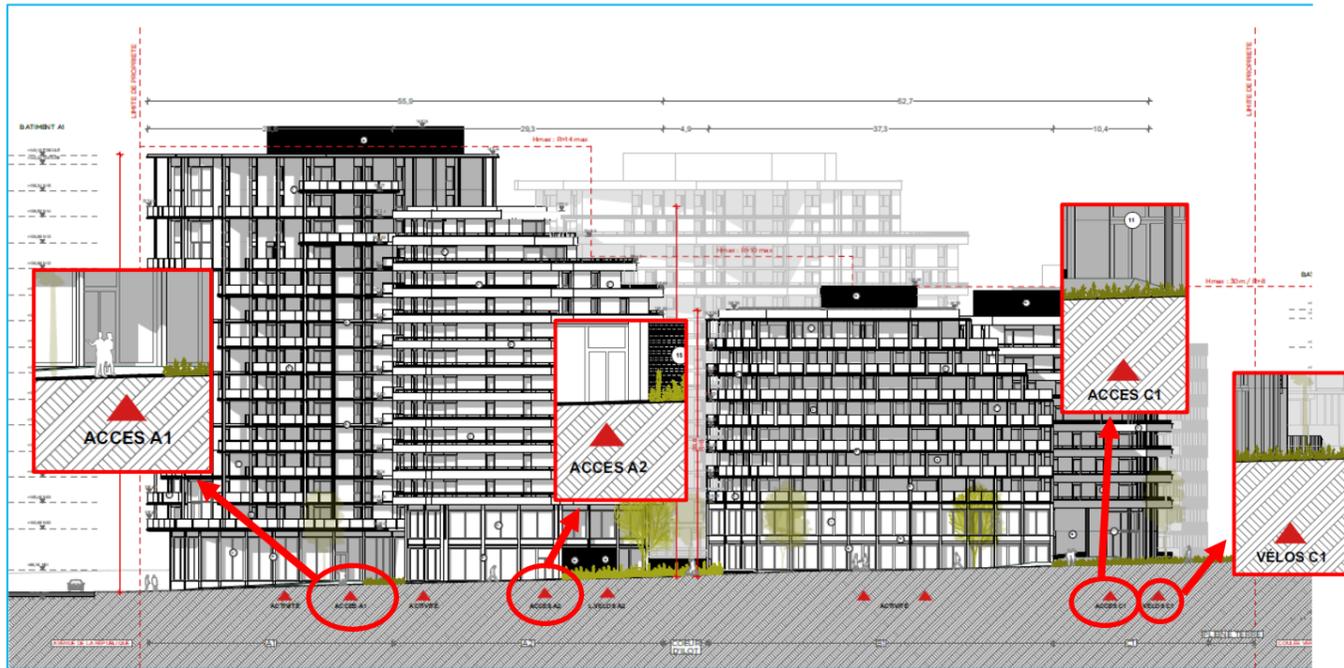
Coupe longitudinale de la façade de l'Avenue de la République (Source : PPX Architecture)
